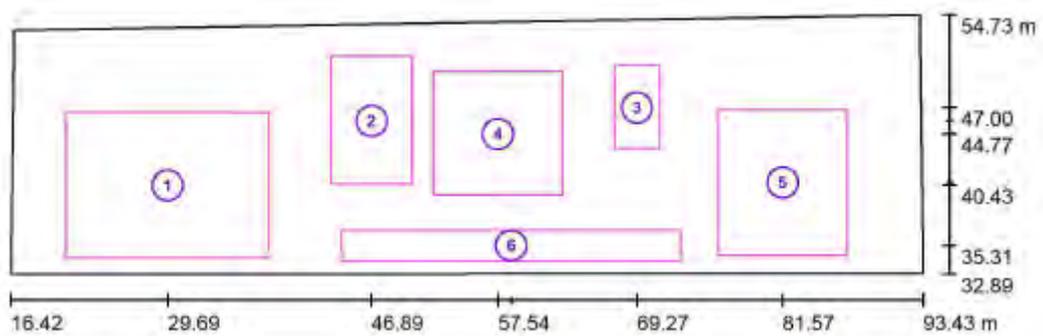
Plano de corte de superficie de cálculo en propuesta de mejora
